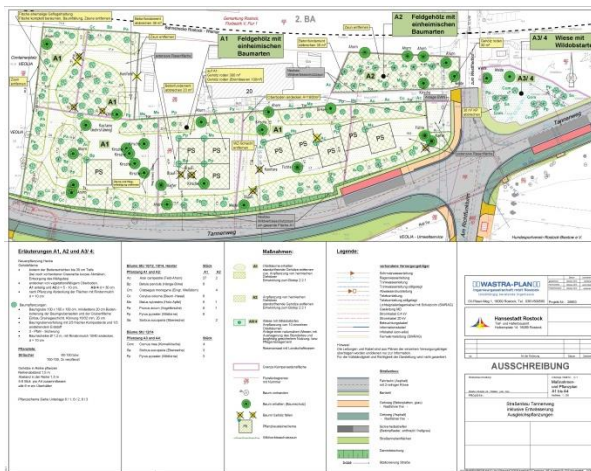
Lageplan Ausgleichspflanzung Tannenweg
